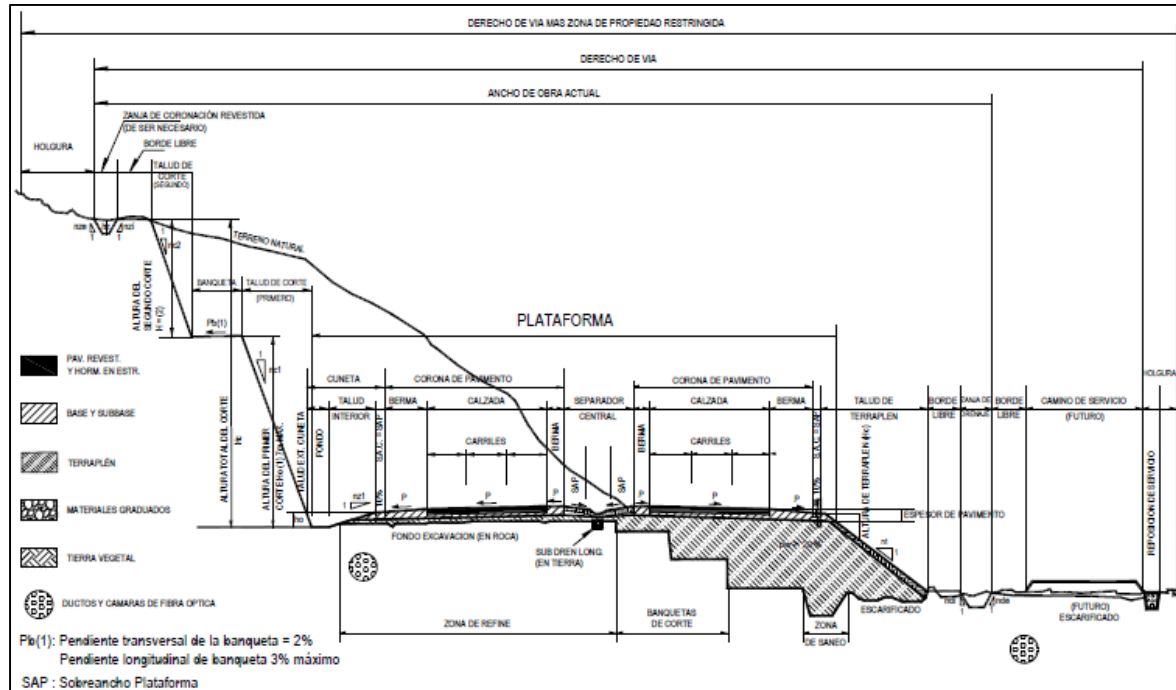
Sección transversal tipo a media ladera para una autopista en tangente
